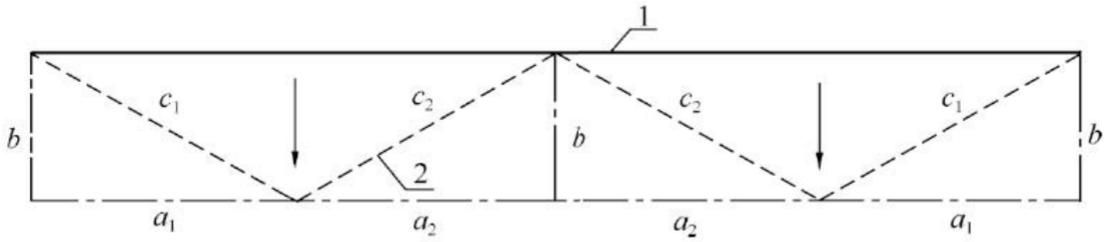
设 1 根中间撑棍时总伸长量的计算简图
